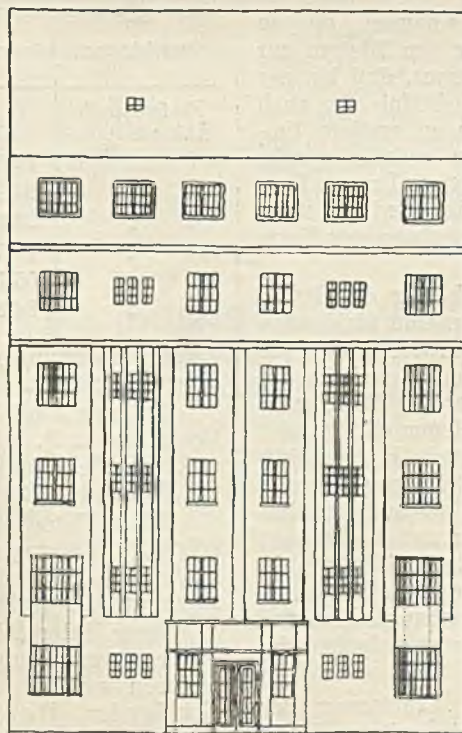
Massenmiethaus mit 18 Wohnungen. Hierzu Grundriß des Sechsfamilienhauses. Architekt B. D. A. Stoffregen in Bremen
